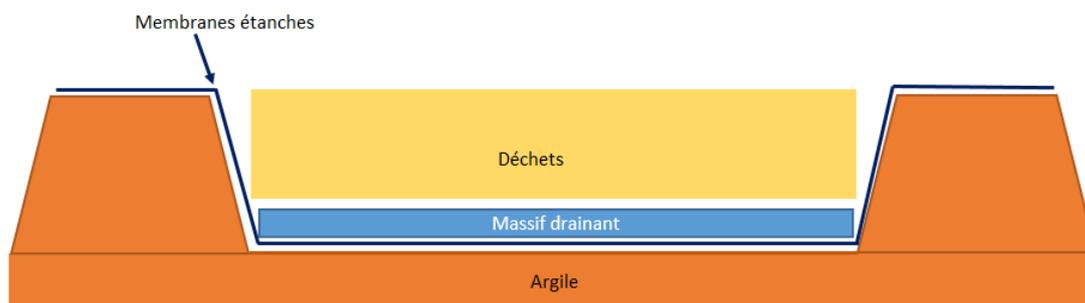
Coupe schématique type d'un casier étanche de stockage de déchets
